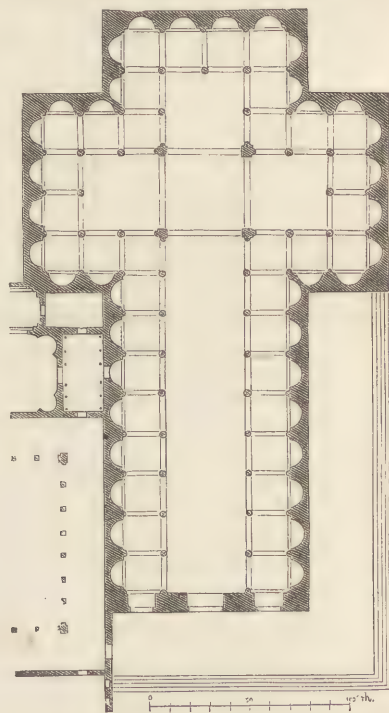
S. Spirito zu Florenz. Grundriss.
